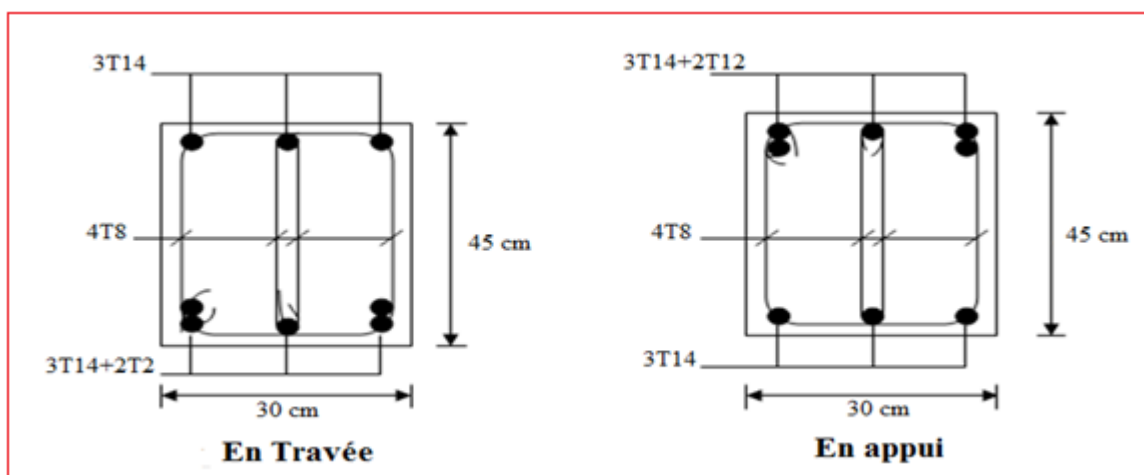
Ferrailage des P.P 1^{er} ; 2 et 3^{eme} étage.
